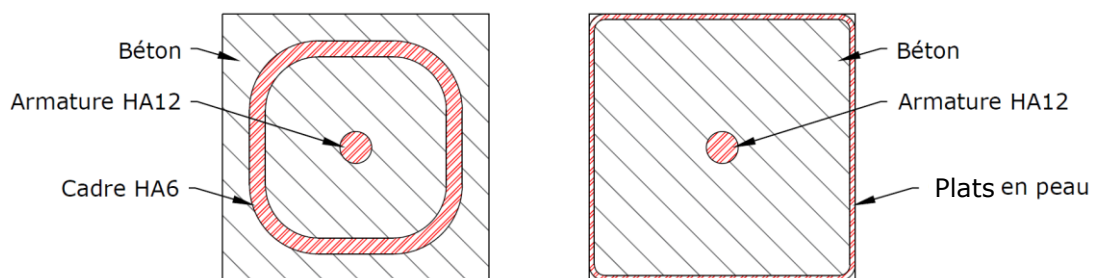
Sections confinées avec ferrailage passif interne et ferrailage passif externe.
